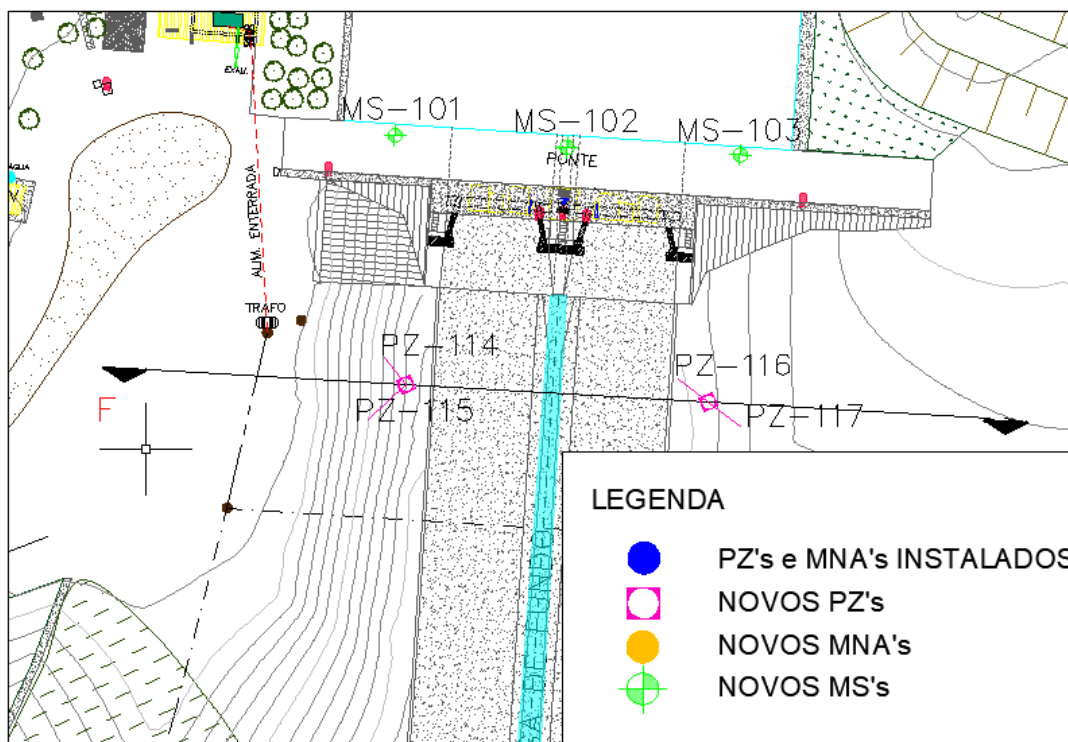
Planta Baixa de localização dos instrumentos no Vertedouro
